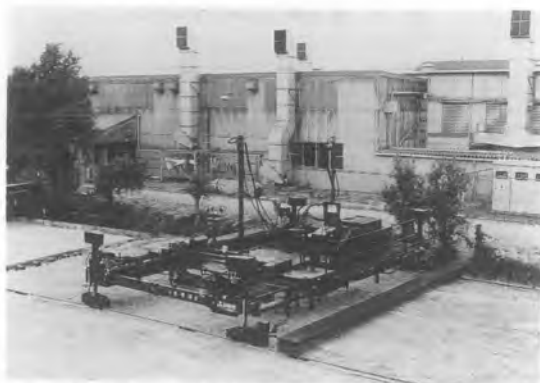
(c) 川崎 KL 85 A コンクリートレベラ
